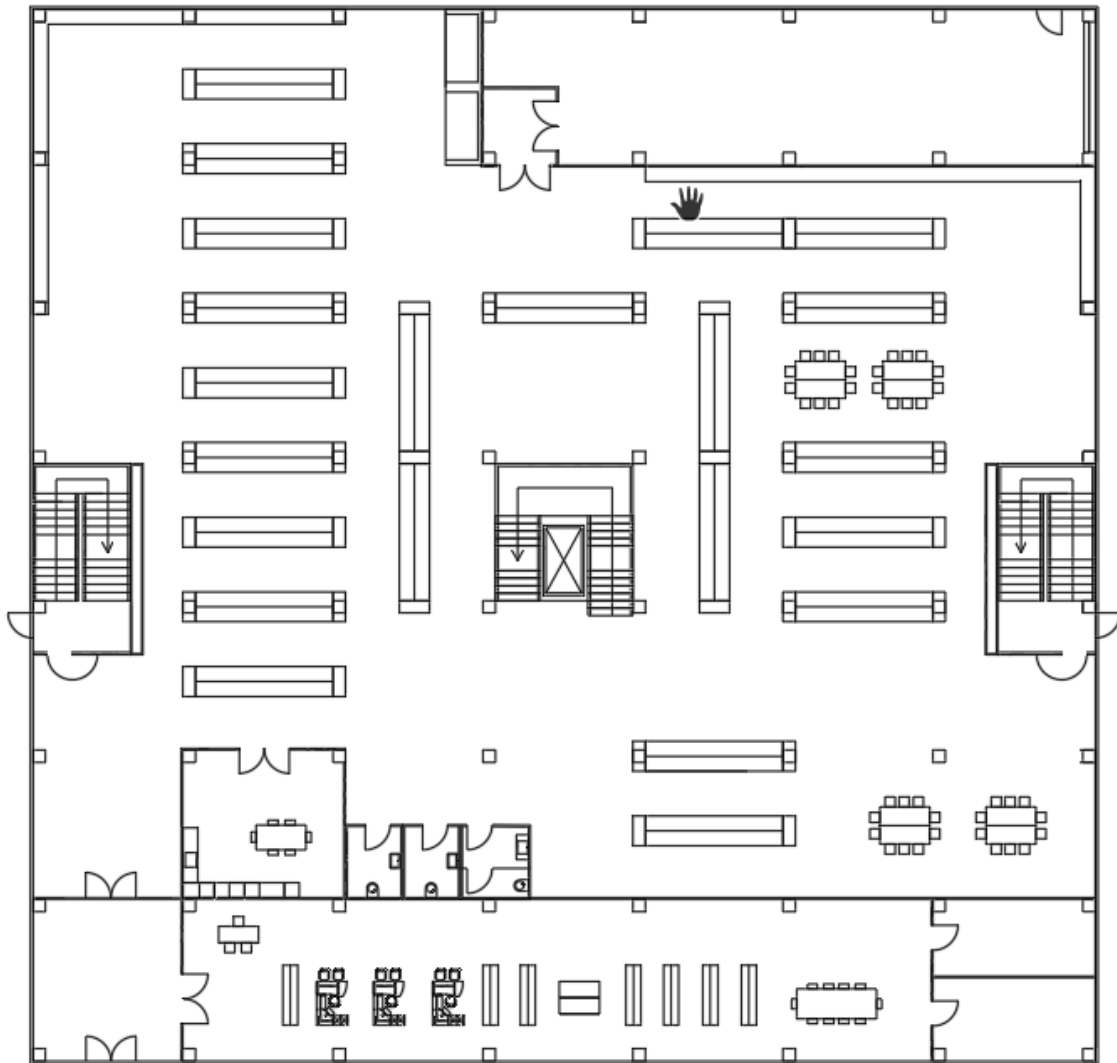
Planta tipo del edificio objeto de estudio (Planta baja).
